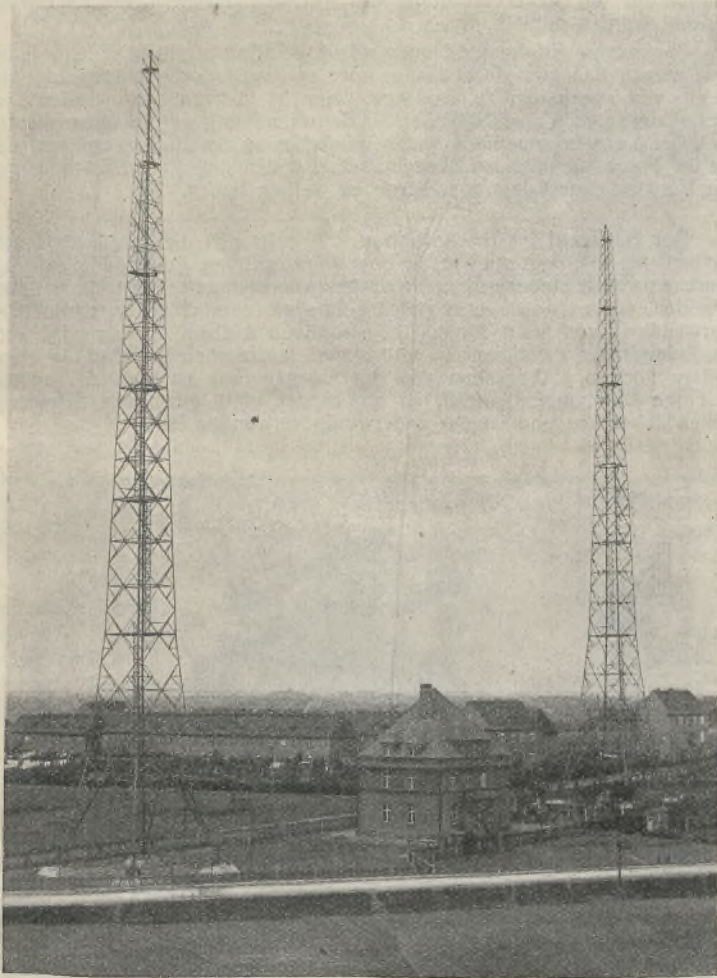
Turmpaar der Rundfunk-Sendeanlage Stettin.
